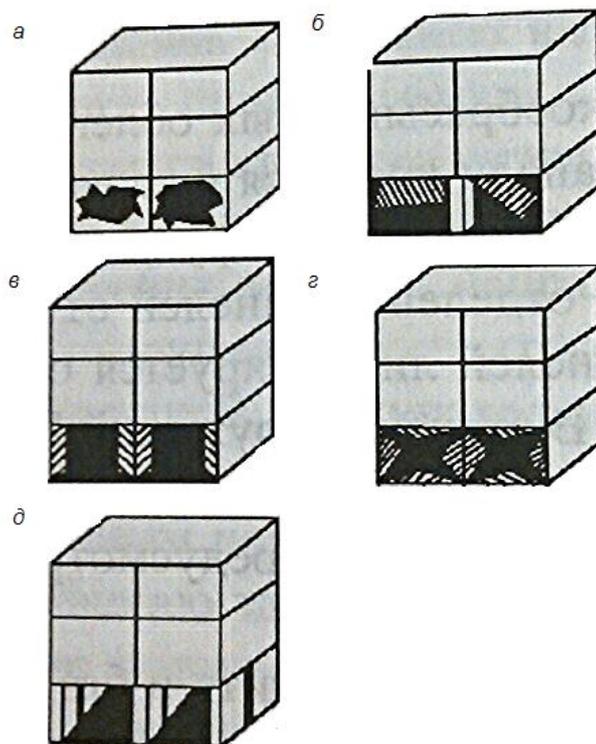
Технические решения цунамистойких зданий: а – легкоразрушаемые конструкции (остекления помещений); б – легкобрасываемые конструкции (метало-пенопластовые панели); в – предохранительные конструкции; г – организованно разрушаемые конструкции; д – здания без ограждающих конструкций на колоннах.
